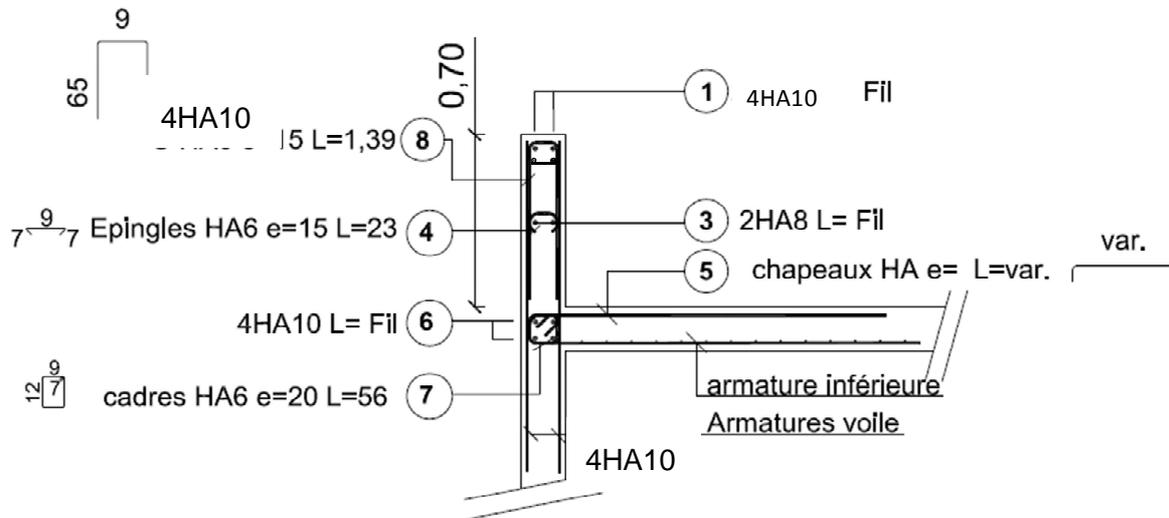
Schéma armature solage sur un voile de vide sanitaire
